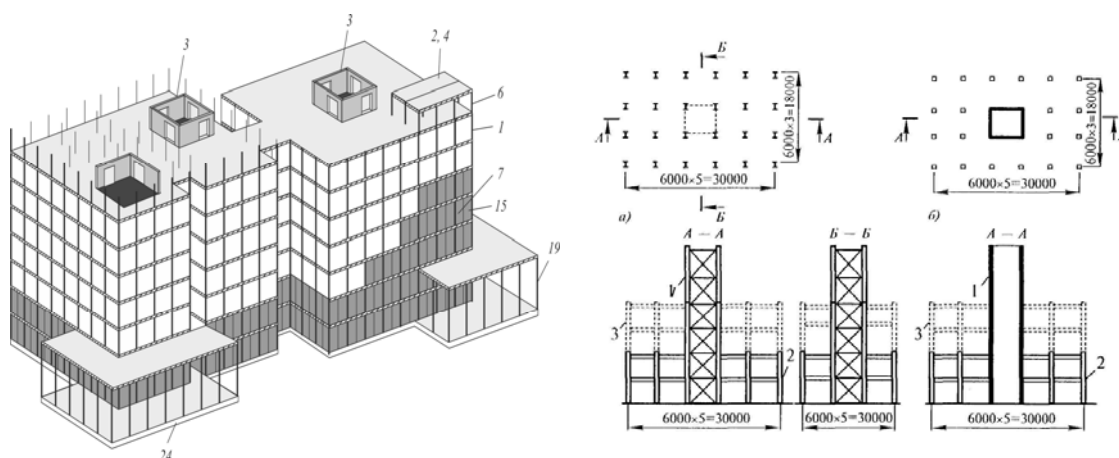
Схема возведения каркаса высотных зданий из строительных модулей с ограждающими сэндвич-панелями и остеклением: а – со стальным ядром жесткости; б – с железобетонным каркасом; 1 – ядро жесткости; 2 - смонтированная часть каркаса; 3 – монтируемая часть каркаса, строительный модуль 1, пол 2, несущие стены 3, строительный потолок 4, одноуровневые несущие колонны 6, ограждающие панели 7, стеклопакеты 15, удлиненные несущие колонны 19, фундаменте 24
